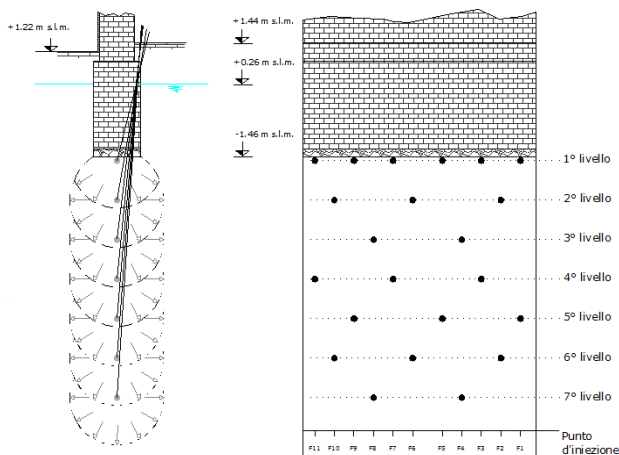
Exemple d'implantation d'injection sur sept niveaux, sous une semelle filante
